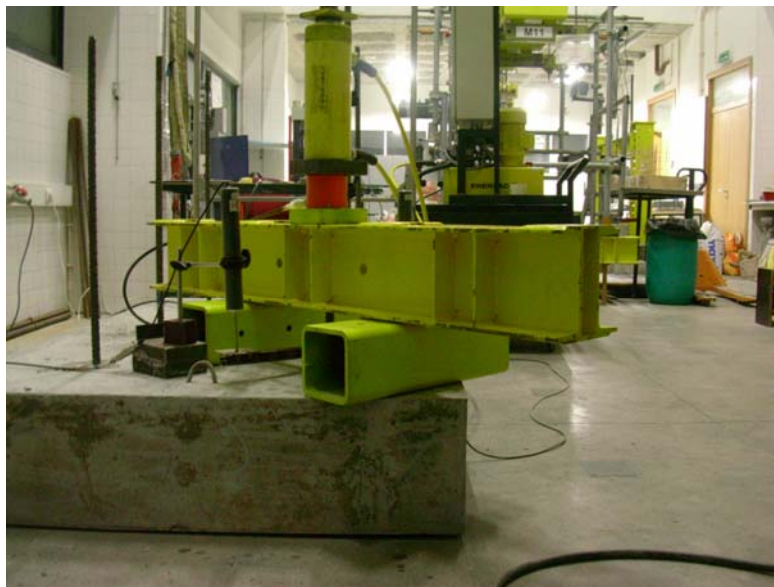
Configuração do ensaio para varões posicionados no canto do maciço de betão
